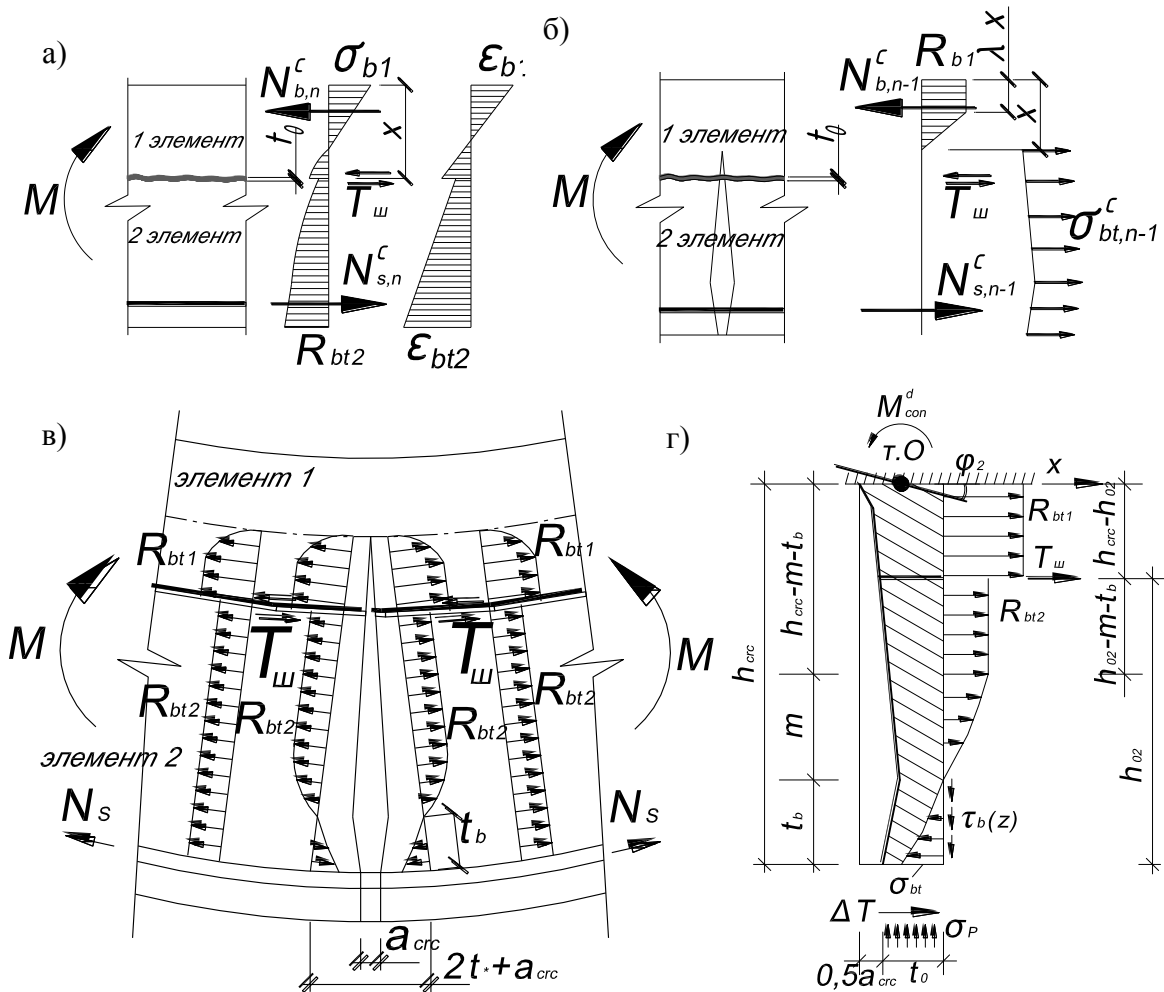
К оценке динамический догрузений изгибаемой железобетонной составной балочной конструкции: составное сечение балки без трещин (а), составное сечение балки с трещиной (б); напряженно-деформированное состояние в растянутом бетоне и около арматурной зоны возле трещины (в); модель двухконсольного элемента (г)
